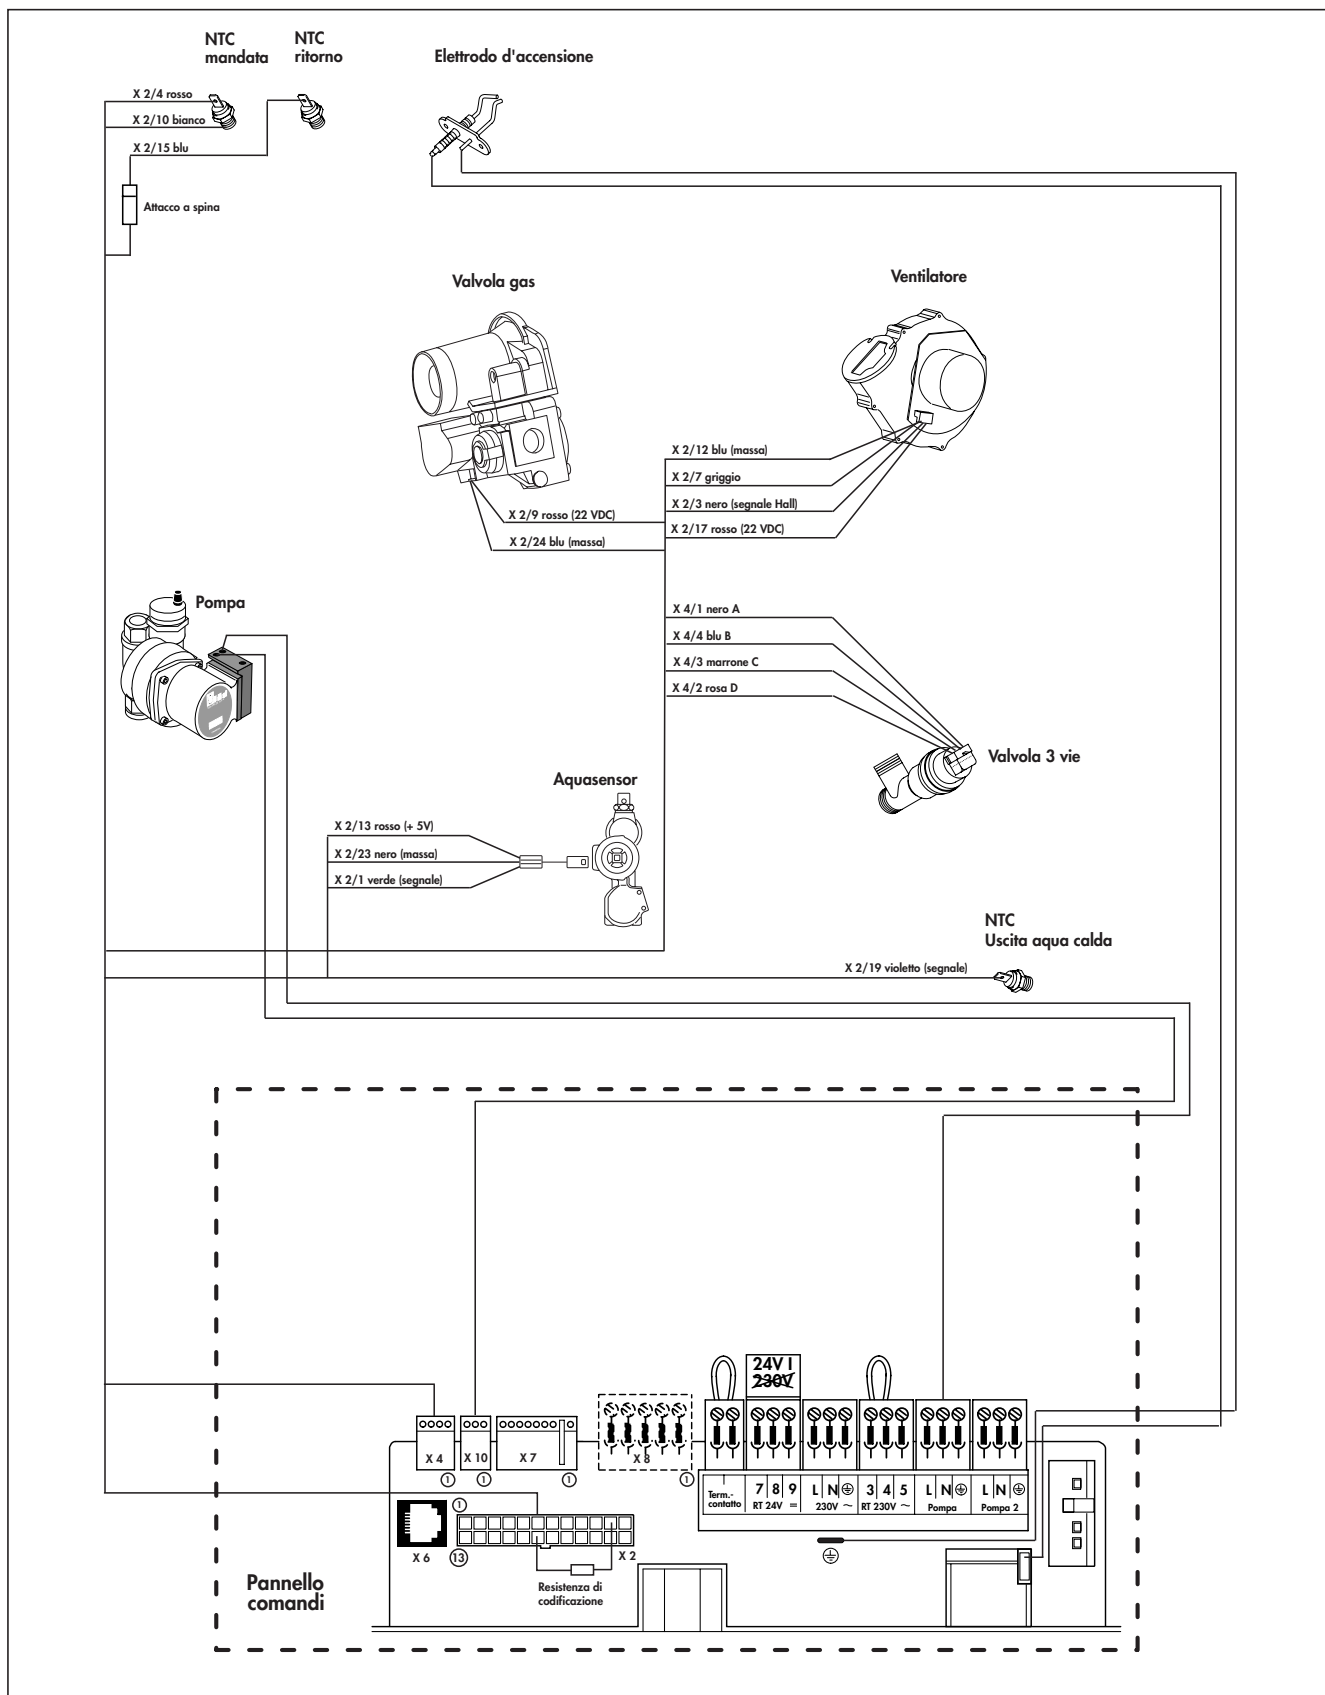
Schema di cablaggio ecoBLOCK VMW 356
